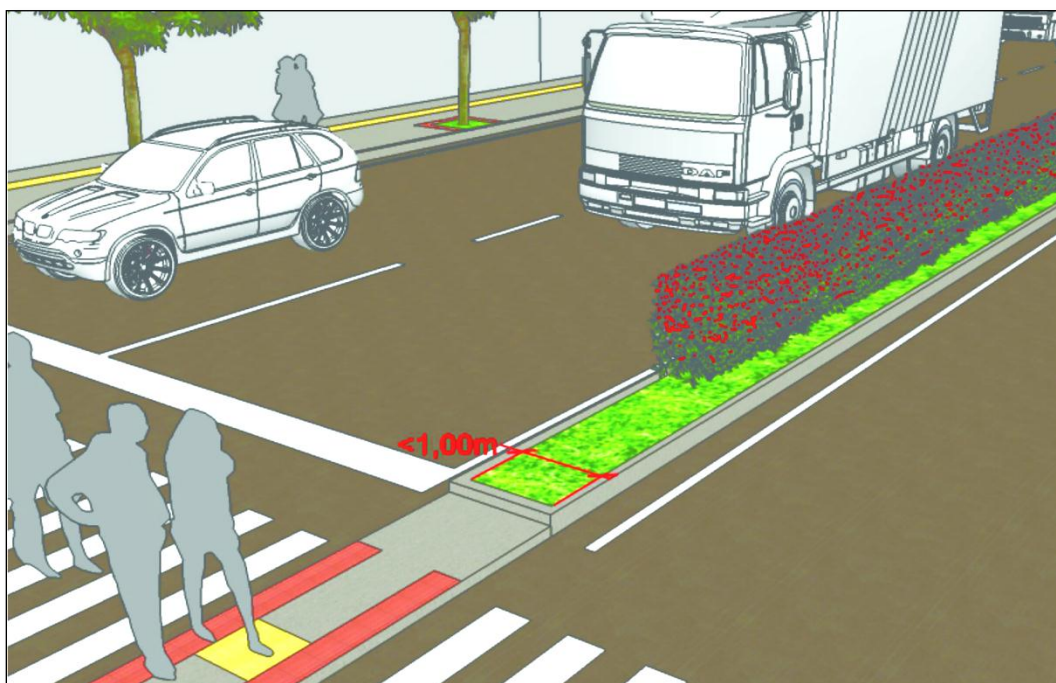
Plantio em canteiro central com largura inferior a 1,00 m.
